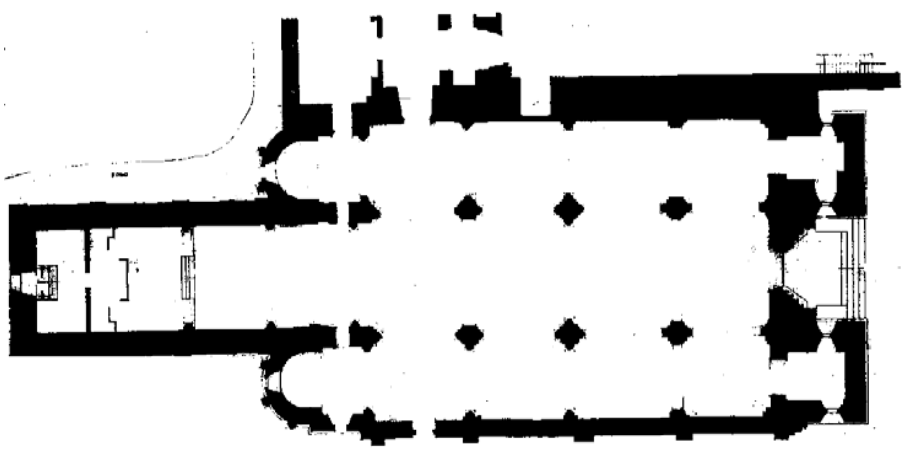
Planta da igreja do mosteiro de Pombeiro [3]
